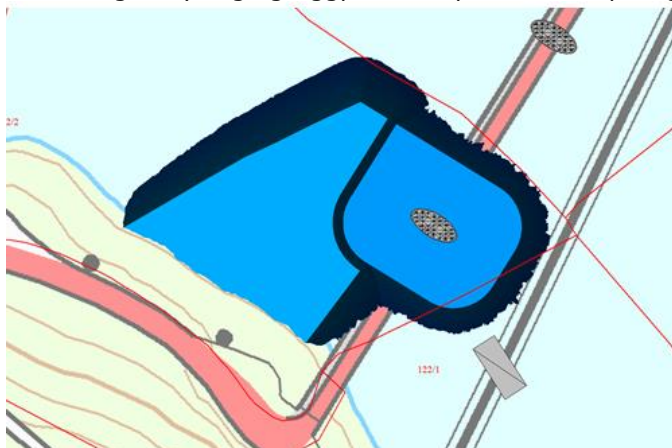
Erosjonssikring rundt akse 2 [5]
